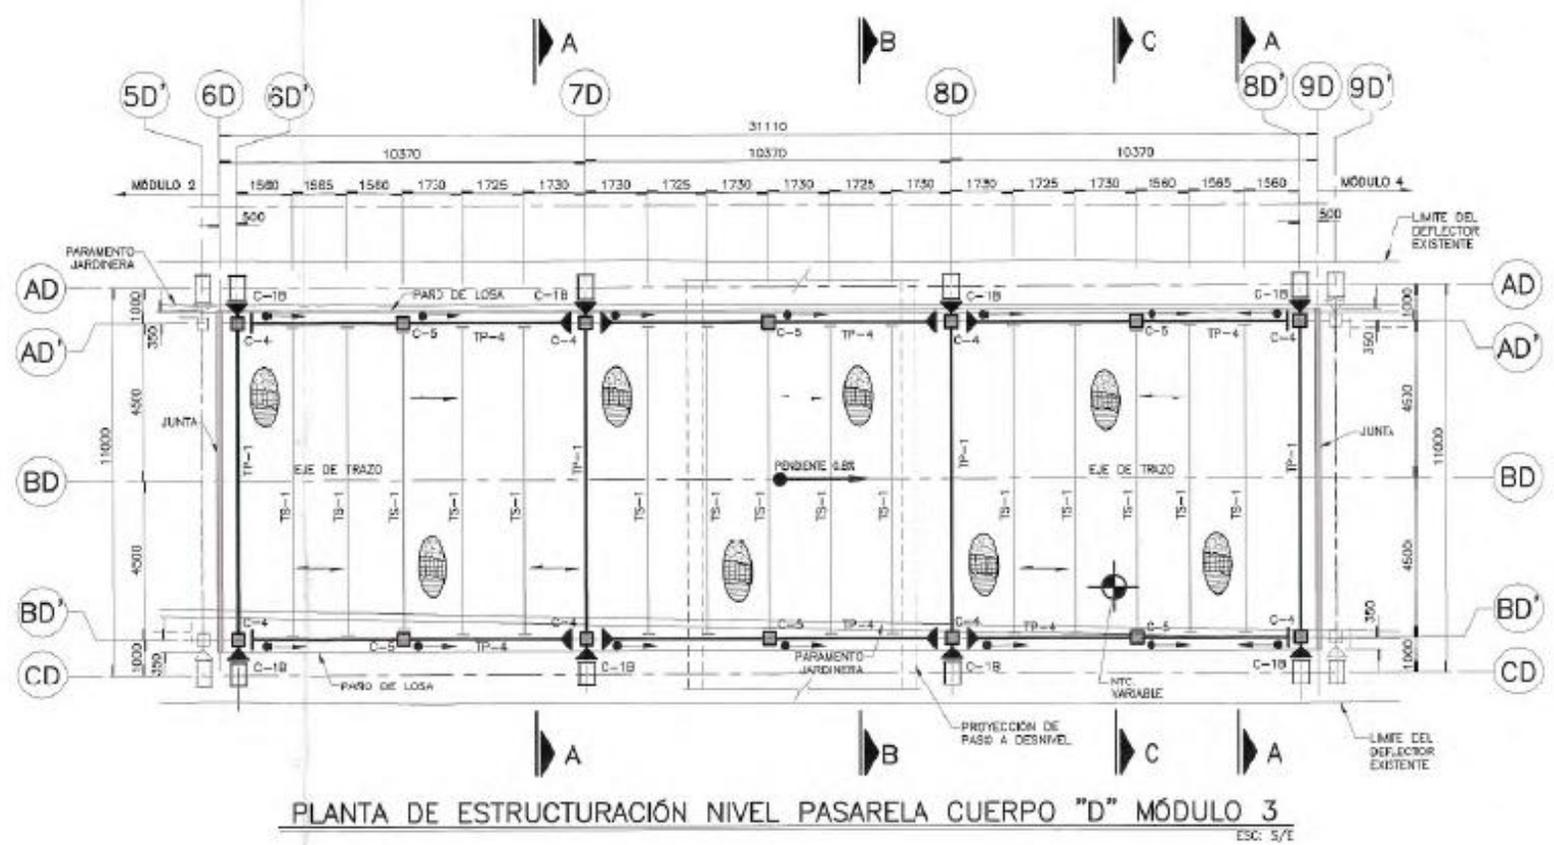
Planta de estructuración nivel pasarela, módulo 3.
